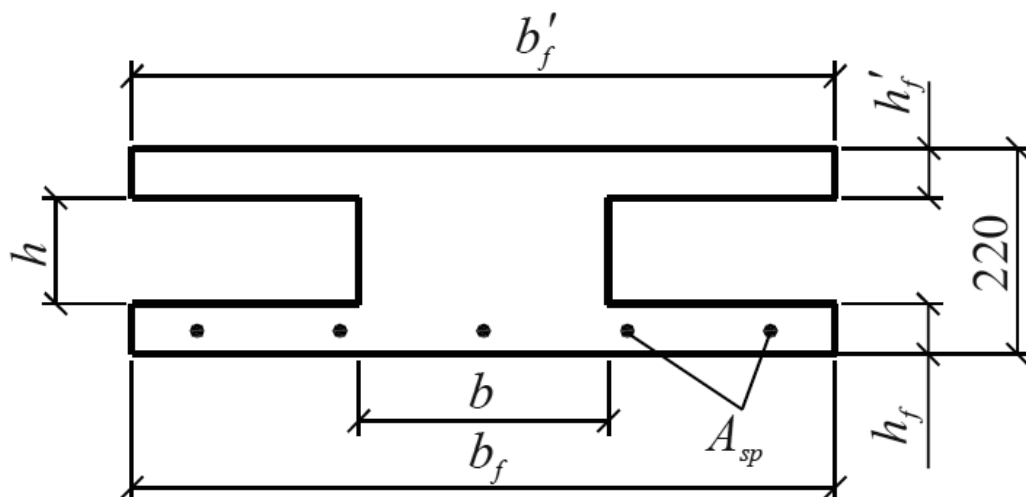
Расчетное сечение плиты, приведенное к двутавровому.
